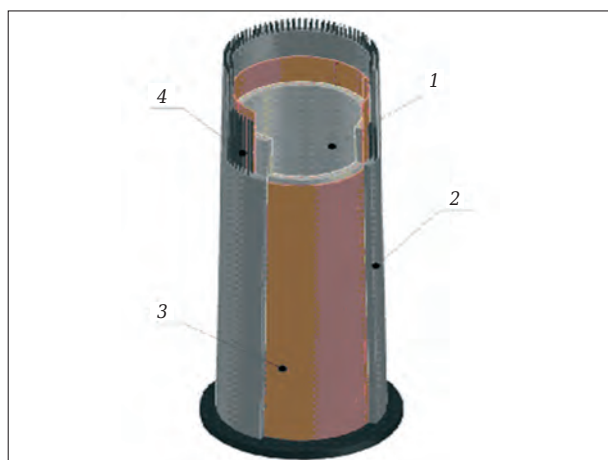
Схема монтажа монолитной футеровки трубы в разрезе: 1 — монолитная теплоизоляционная футеровка; 2 — несущая железобетонная оболочка; 3 — разделительная мембрана; 4 — арматура
